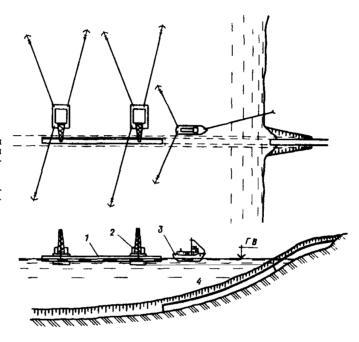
Схема расположения механизмов и оборудования для секционной укладки трубопровода
